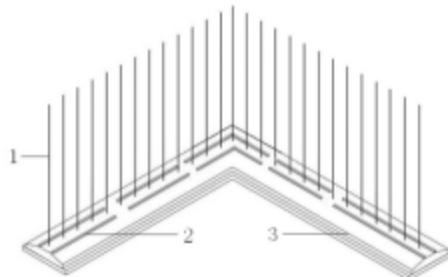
空腔聚苯模块墙体限位卡槽安装示意
